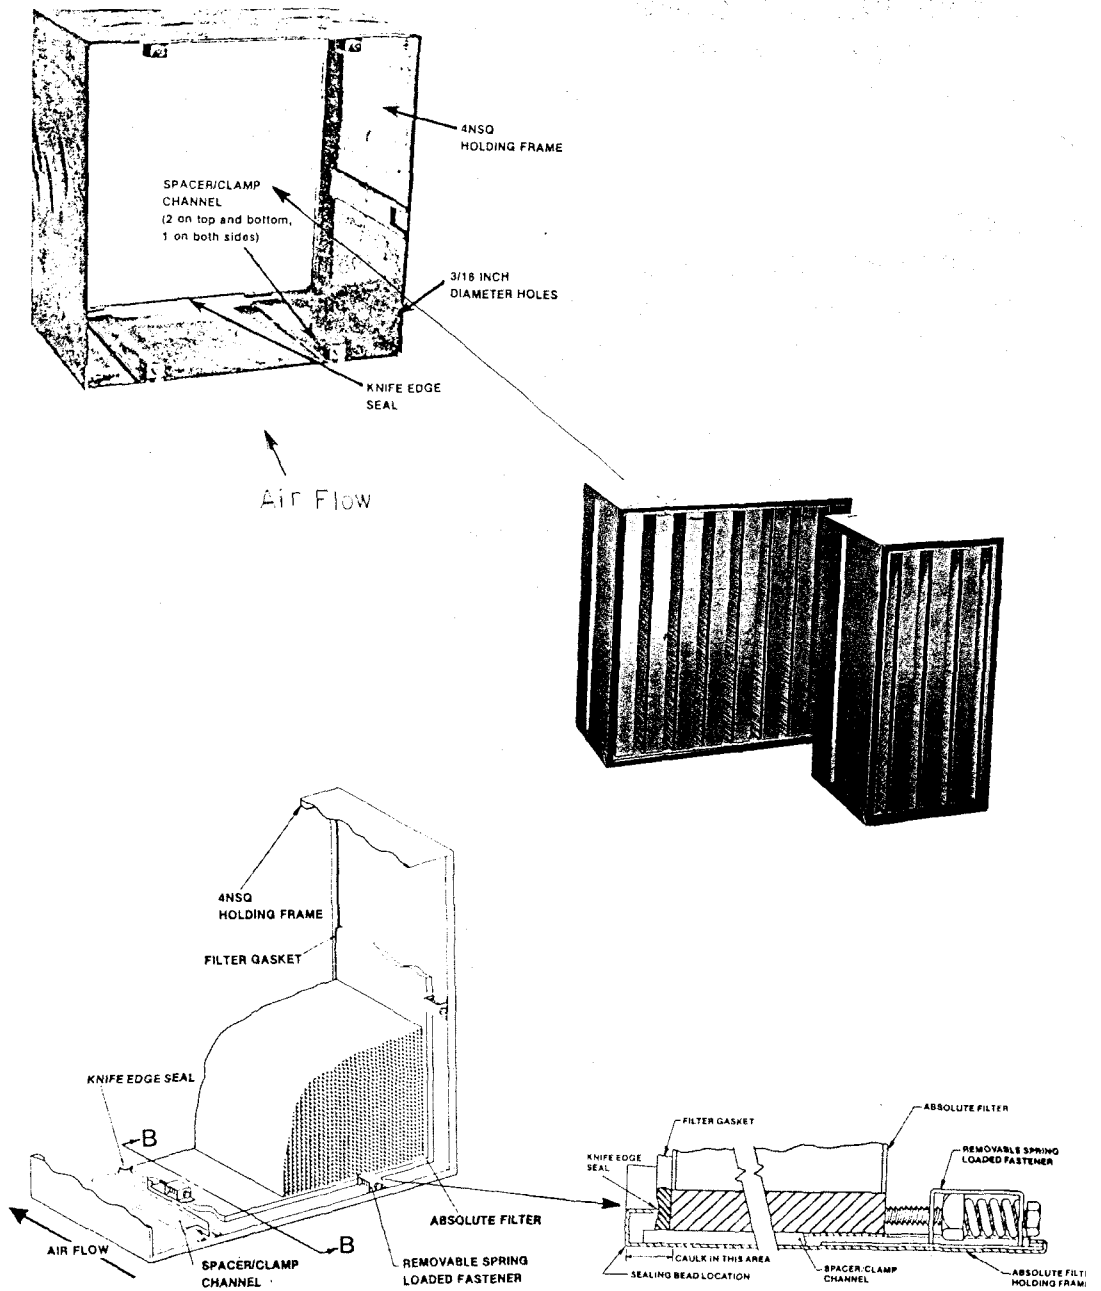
HOLDING FRAME에 의한 BANK TYPE 중성능 FILTER 설치도
